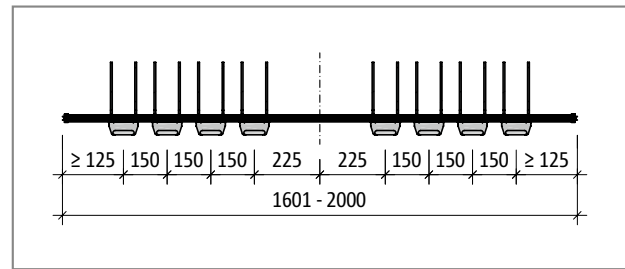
Schöck Tronsole® Typ T-V8-H...-L1601 bis L2000: Produktgrundriss
